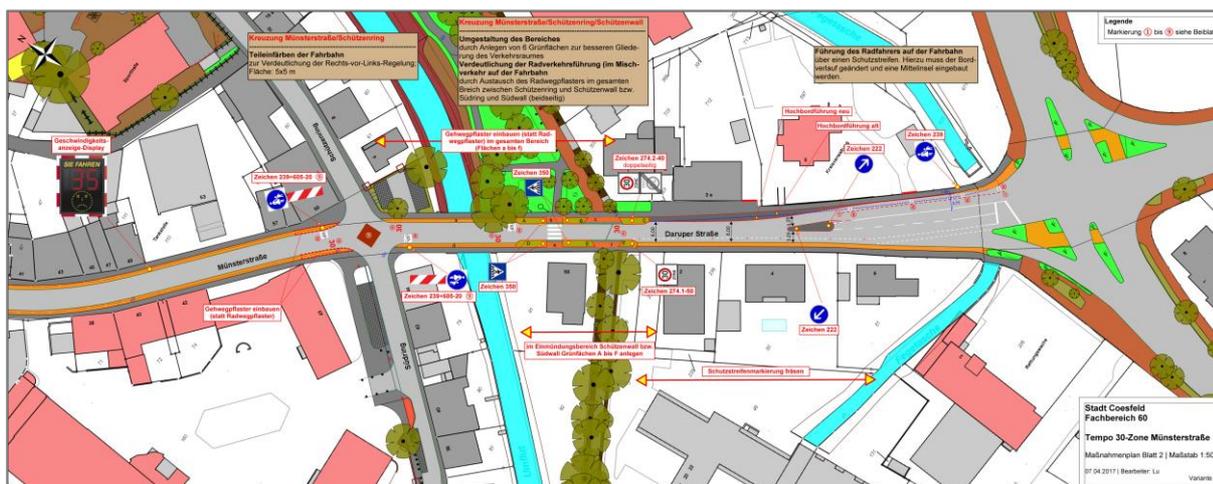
Gesamtplan Umbau Münsterstraße/BvG-Str. – südlicher Abschnitt
